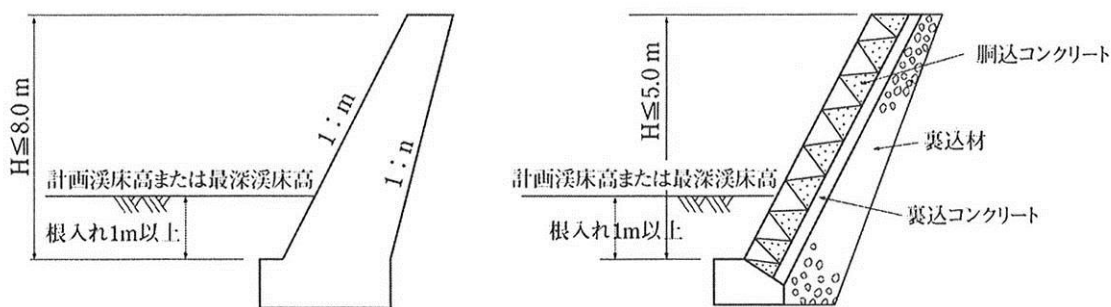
護岸工の根入れ例（砂礫基礎）
